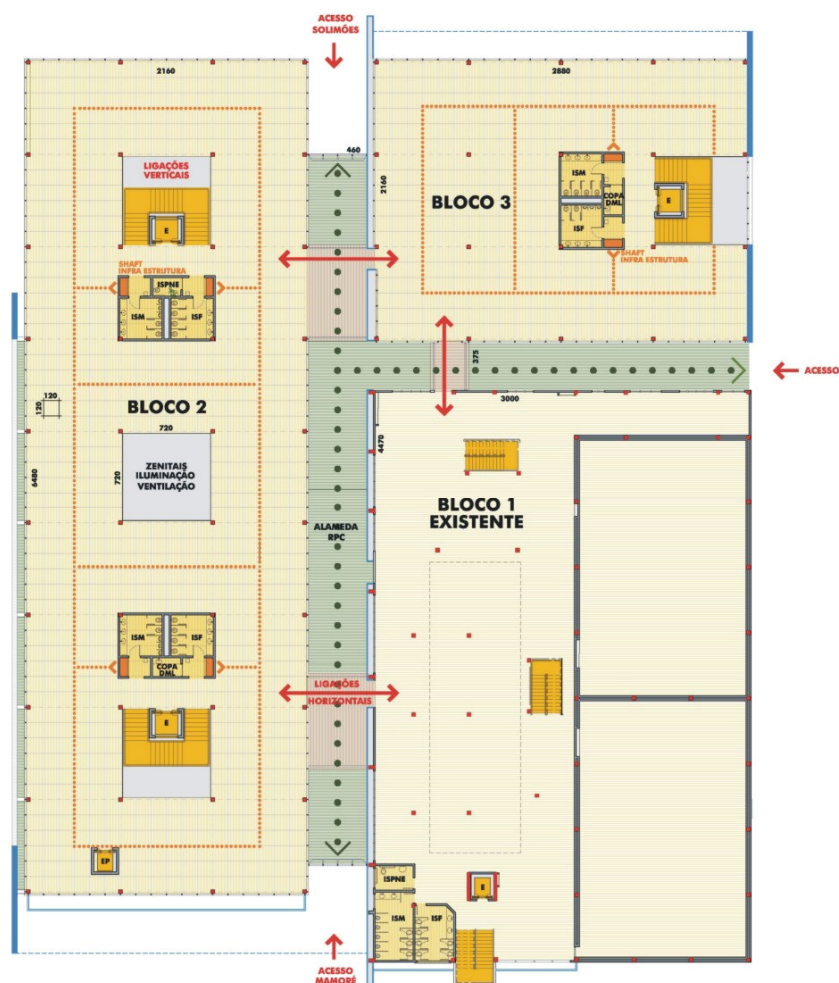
Esquema da planta tipo do edifício sede da RPC (fonte: MCA, 2006).
